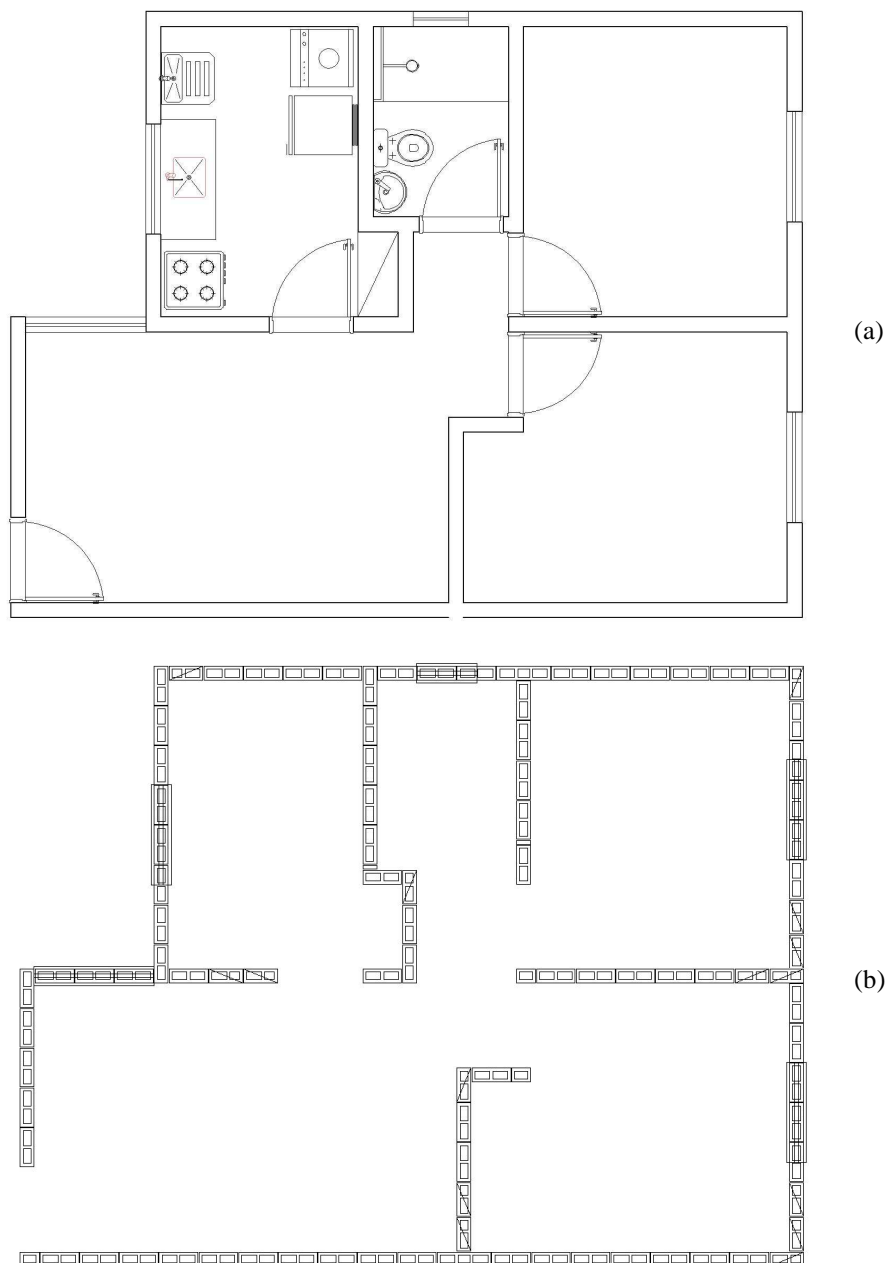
Planta de apartamento de dois quartos de edifício em alvenaria estrutural voltado para o segmento popular localizado em Samambaia – DF (a) e sua equivalente planta de execução (b).
